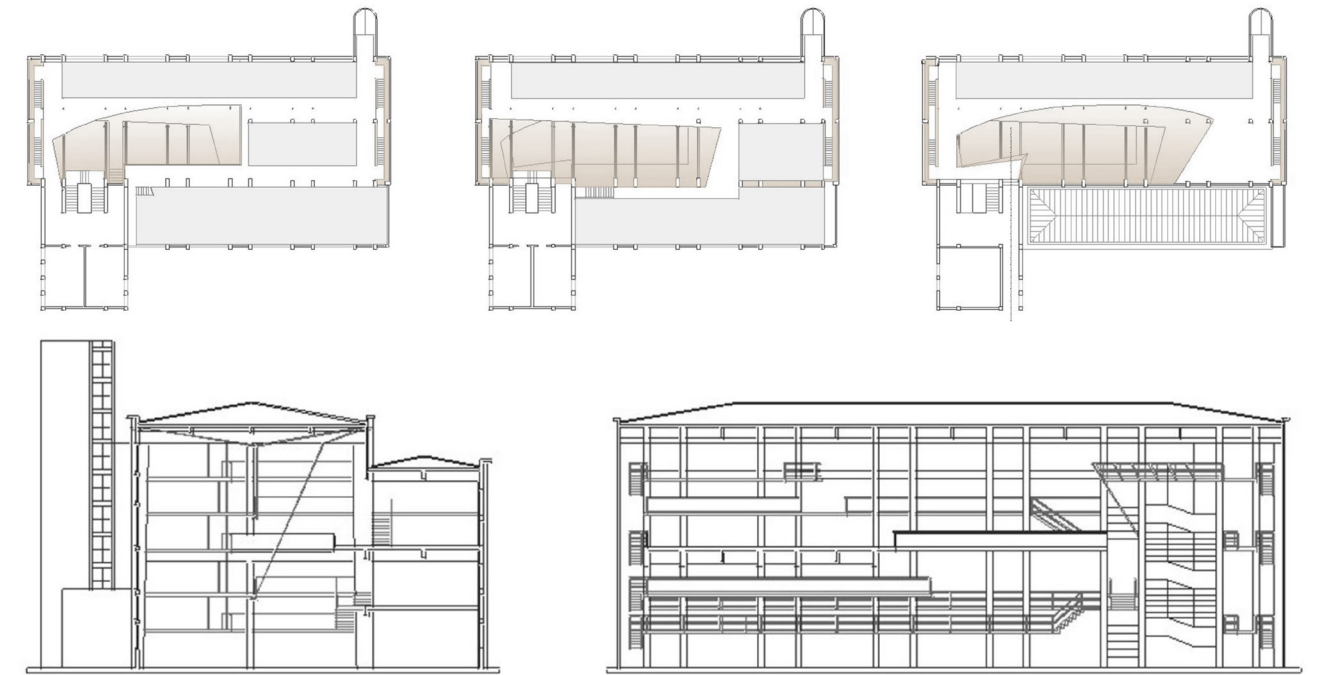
| Plantas de los entresijos y cortes de la intervención.
